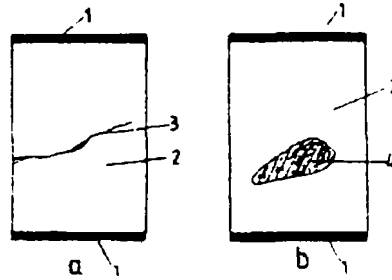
Avarii la pereții din beton armat monolit ;
